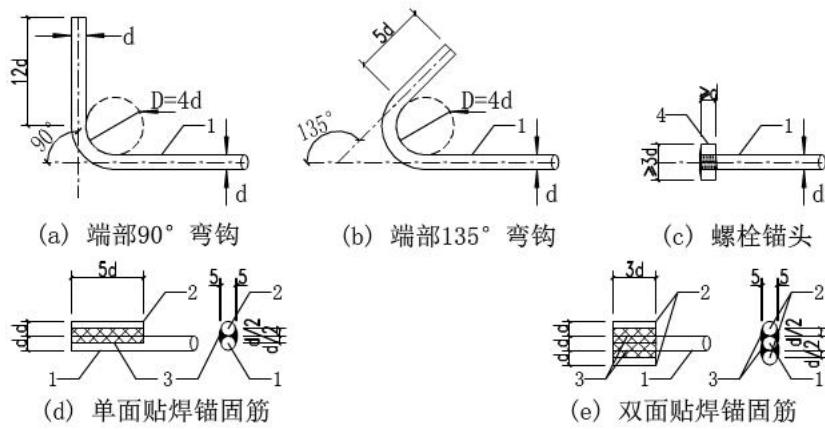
钢筋采取机械锚固措施构造示意
